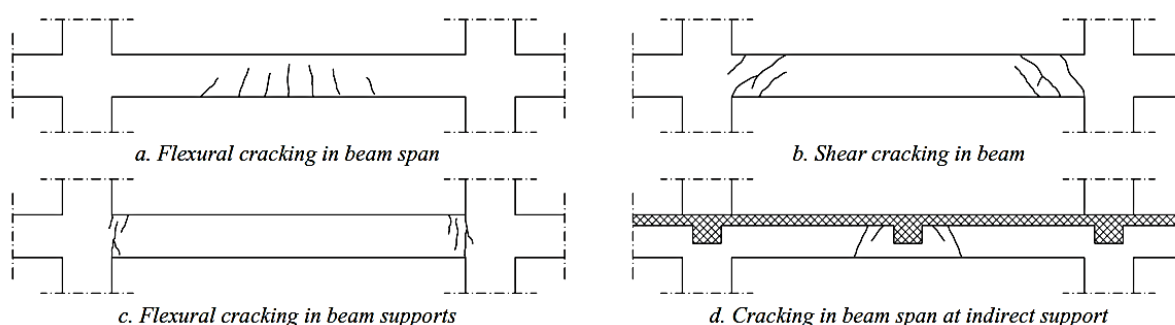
Exemplos esquemáticos de fendilhação em vigas com falta de pormenorização e insuficiente resistência: (a) fendilhação por flexão, (b) fendilhação por corte, (c) fendilhação por flexão junto aos apoios e (d) fendilhação junto a apoio indireto (Elnashai e Di Sarno, 2008).
